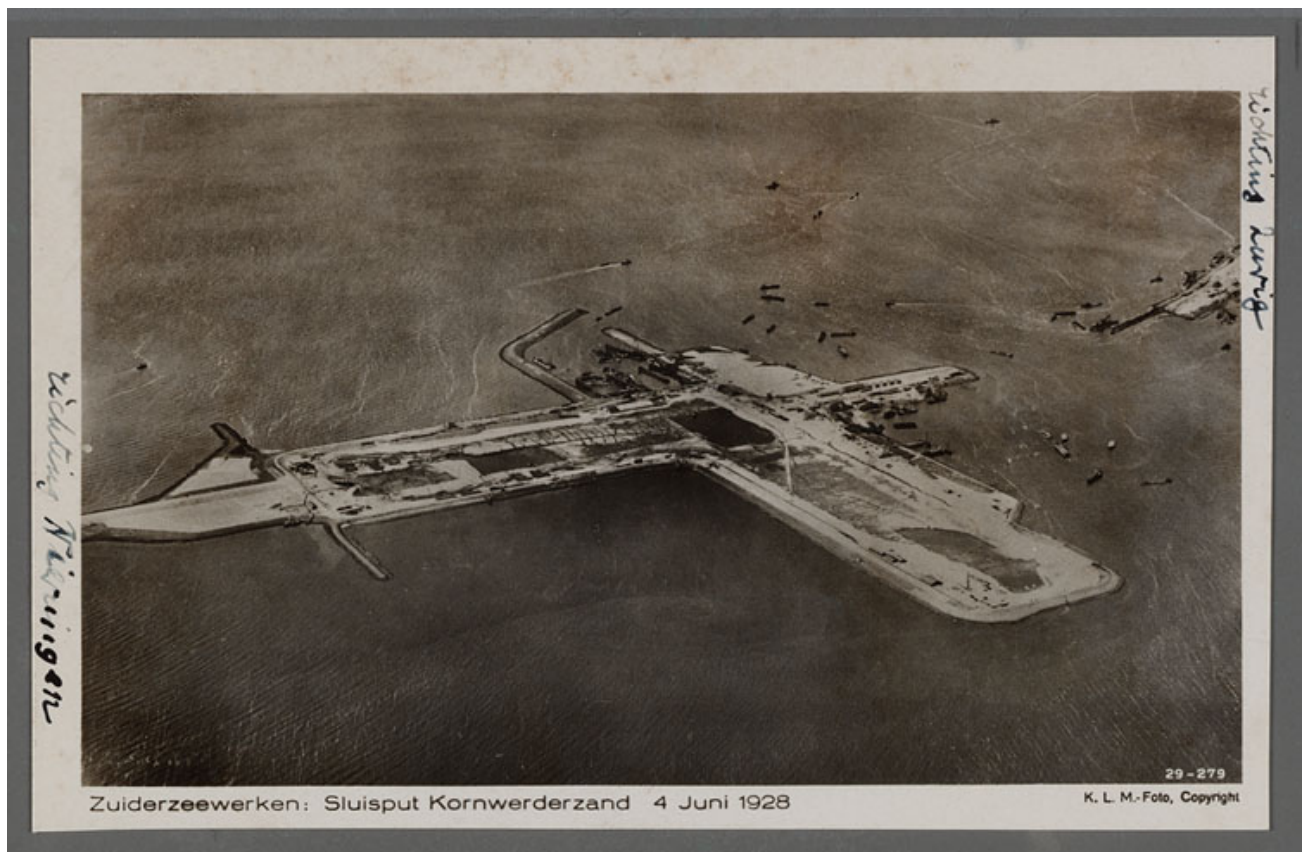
aanleg Kornwerderzand 4-6-1928 (eiland krijgt vorm en wordt bebouwd)
